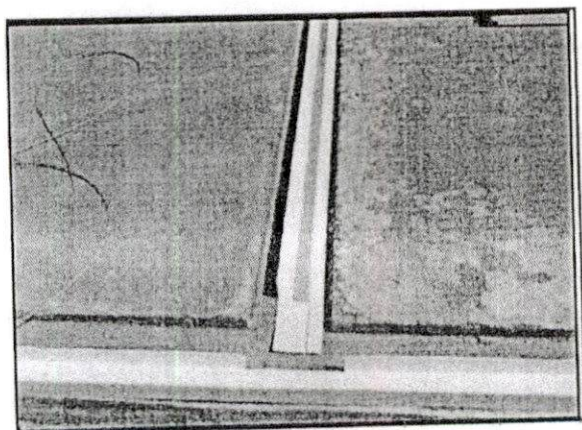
Perfil em PVC para fixação parede com a fundação.
